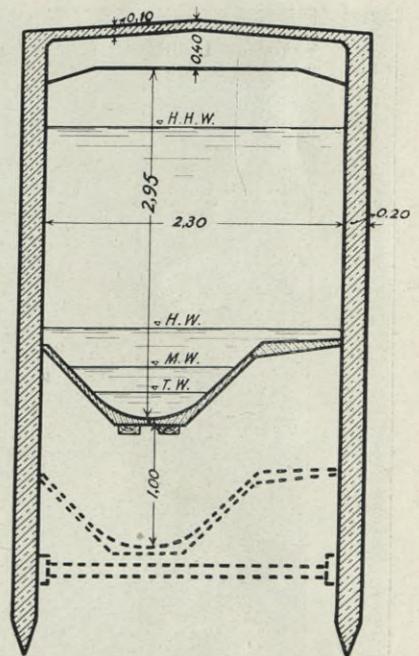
Das Gleiche wie in Abb. 26, aber mit Eisenbetonspundwänden als Seitenwänden. Diese Bauweise wird bei nicht zu großen Abmessungen mit Vorteil da verwendet, wo ohnehin für den Bau Spundwände erforderlich sein würden.
